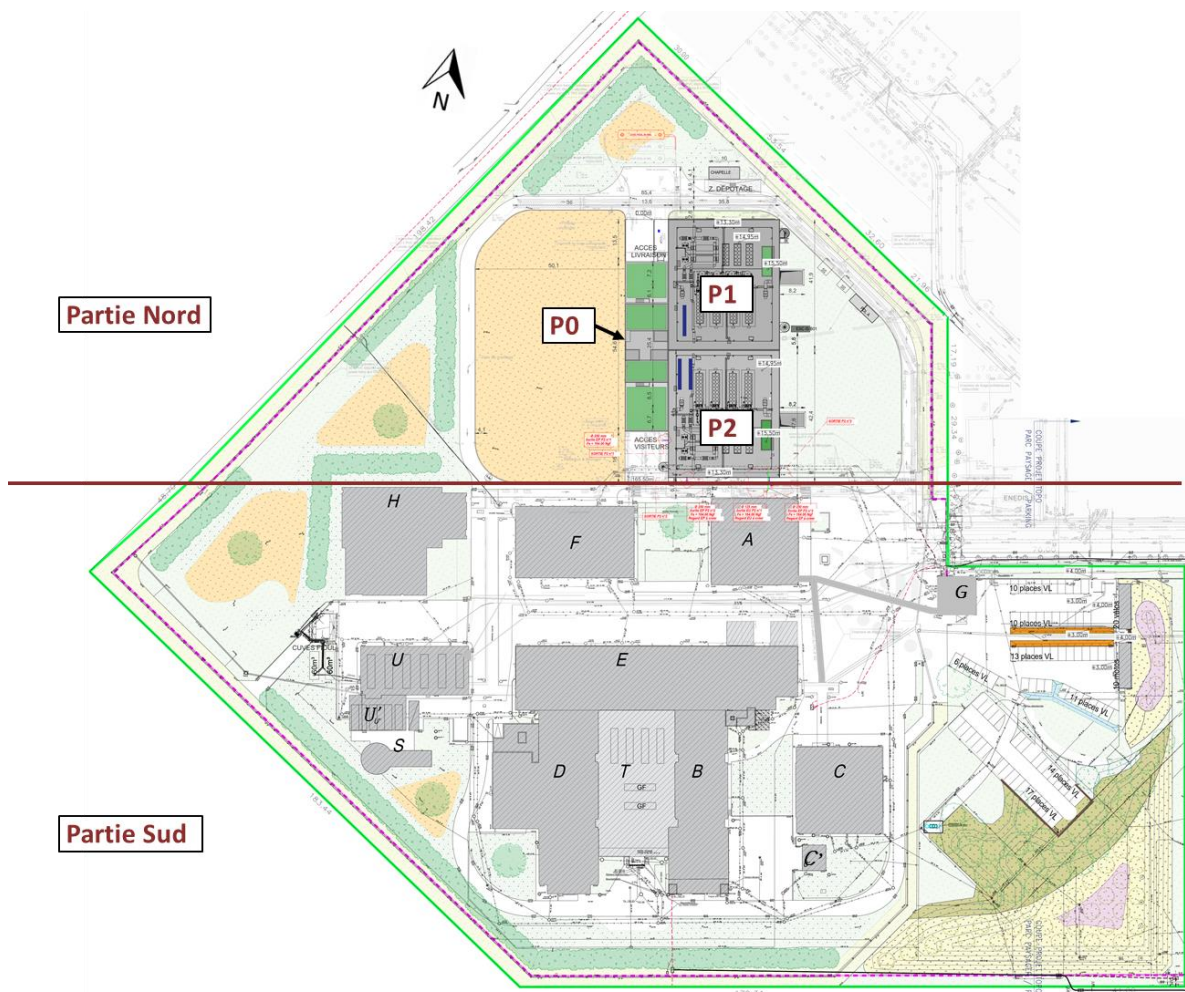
Plan masse du site dans sa configuration projetée avec P2
